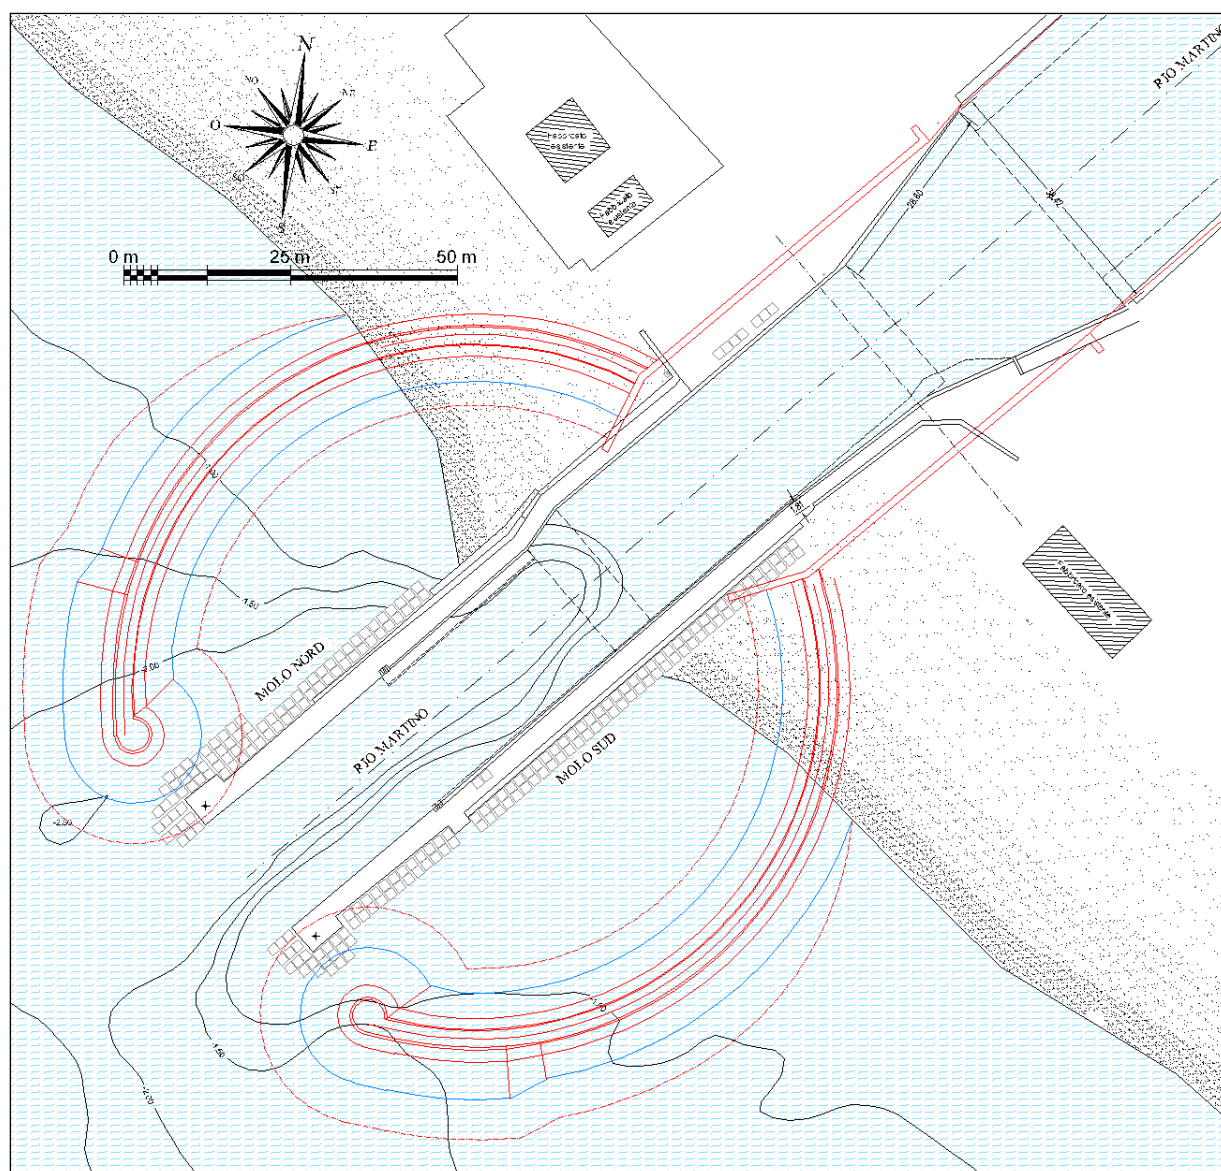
Planimetria di progetto con sovrapposizione moli vecchi e nuovi
